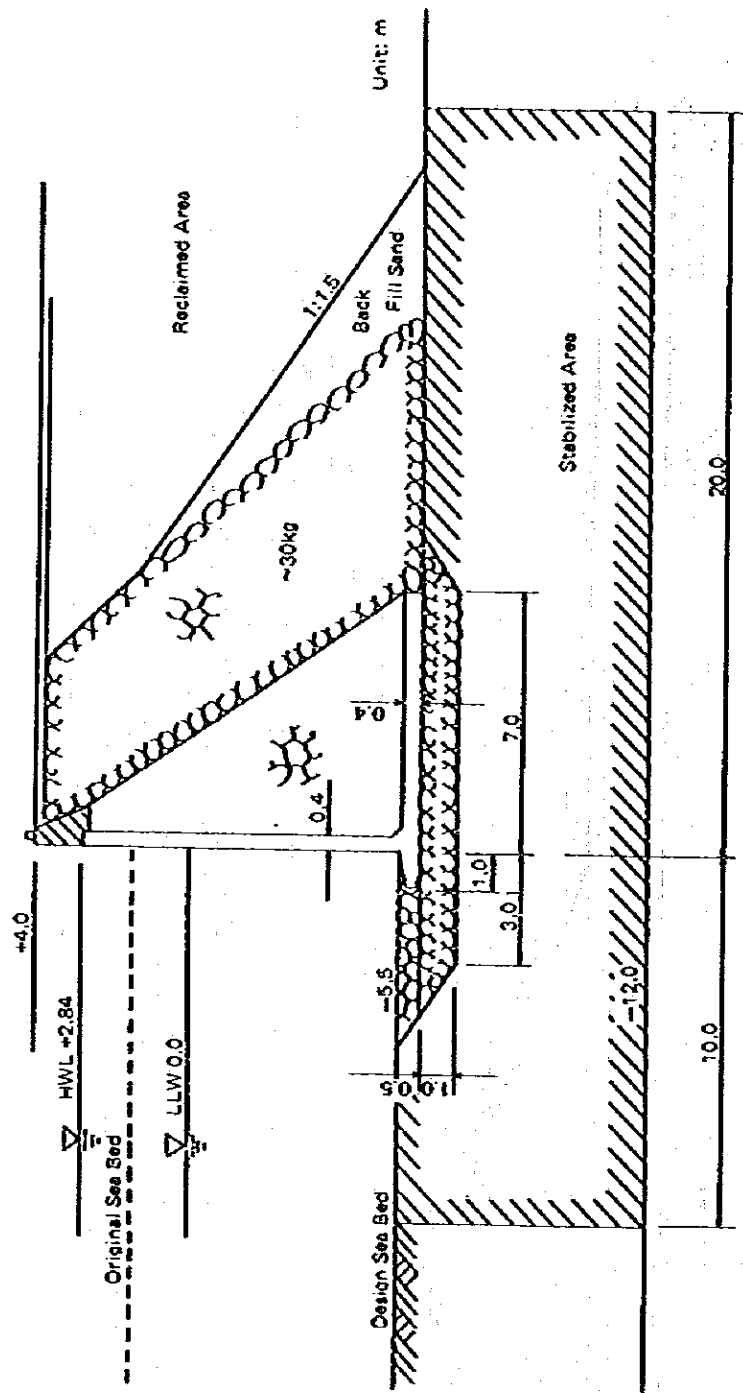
代替案 C (I 型コンクリートブロック基礎) の標準断面図
